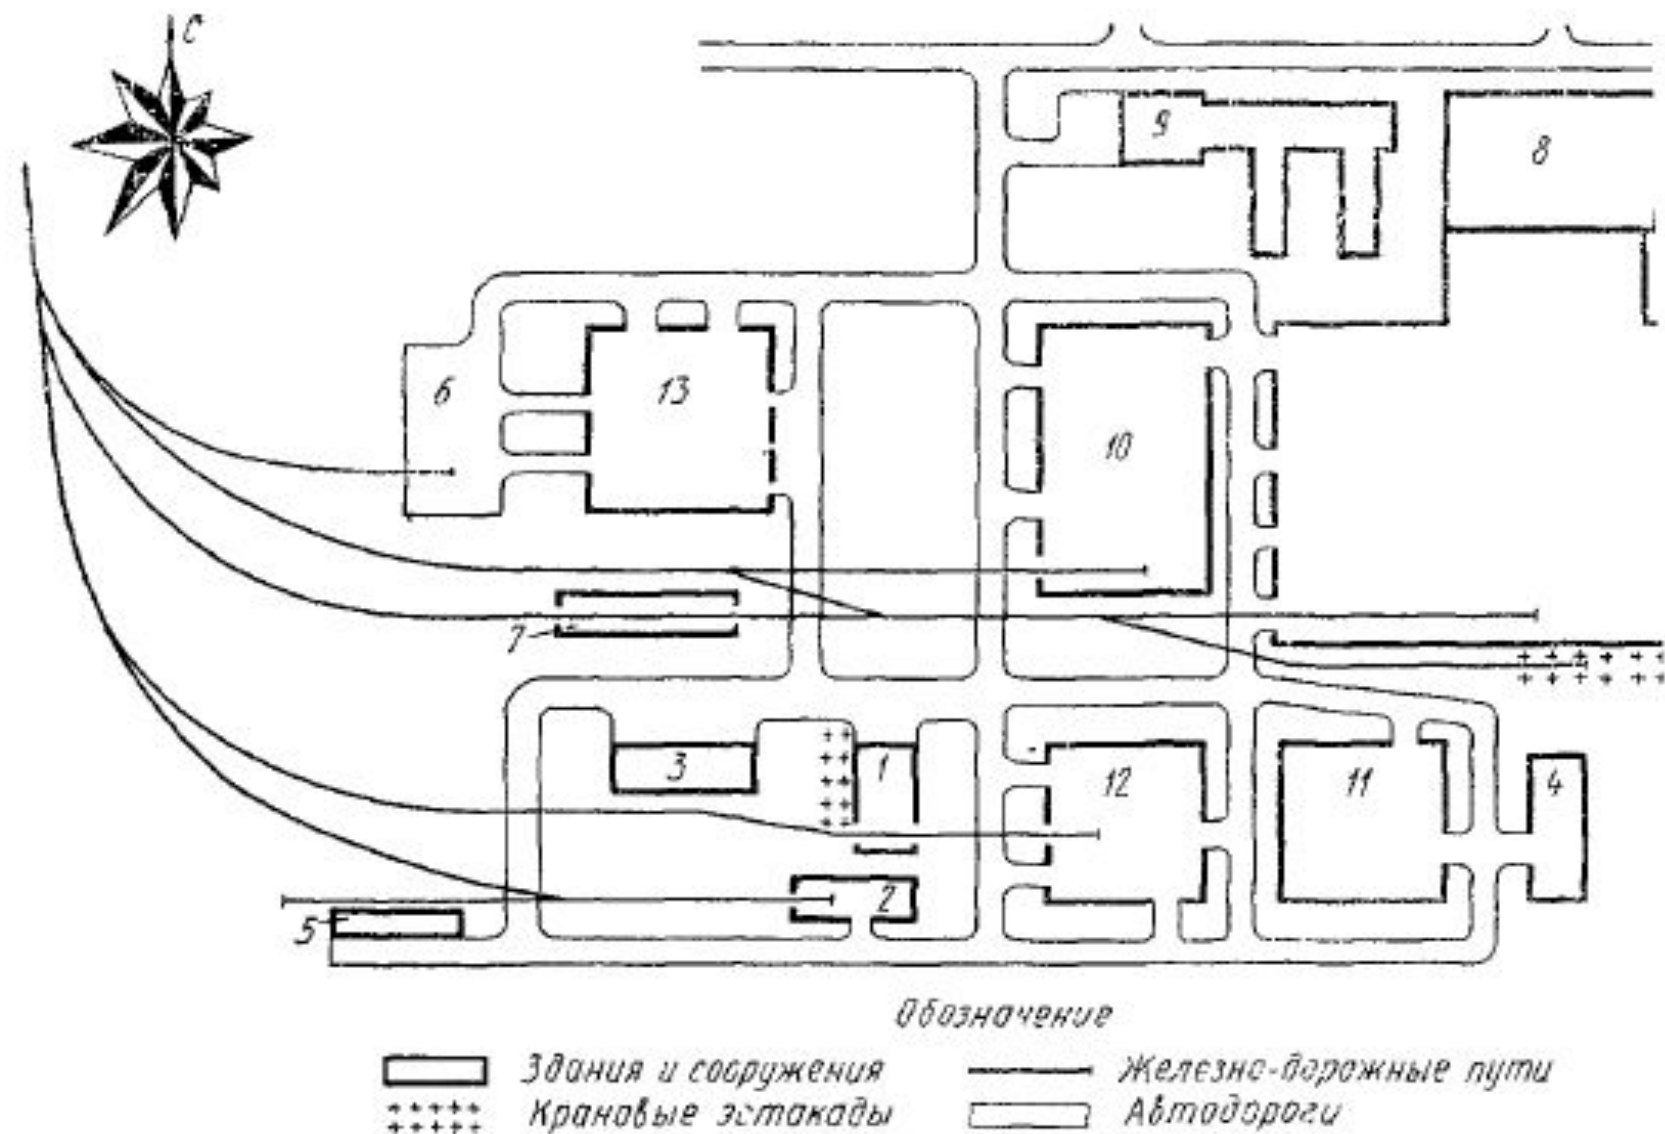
Примерная схема генерального плана станкостроительного завода:
